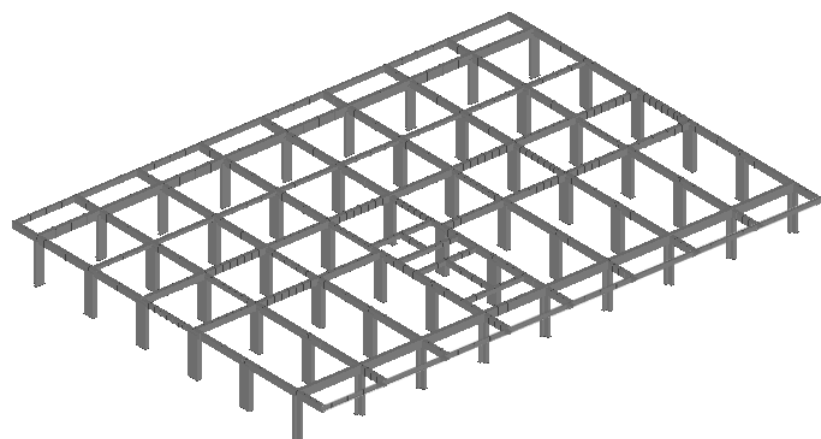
Detalle del modelo "sólido" de la estructura principal.
